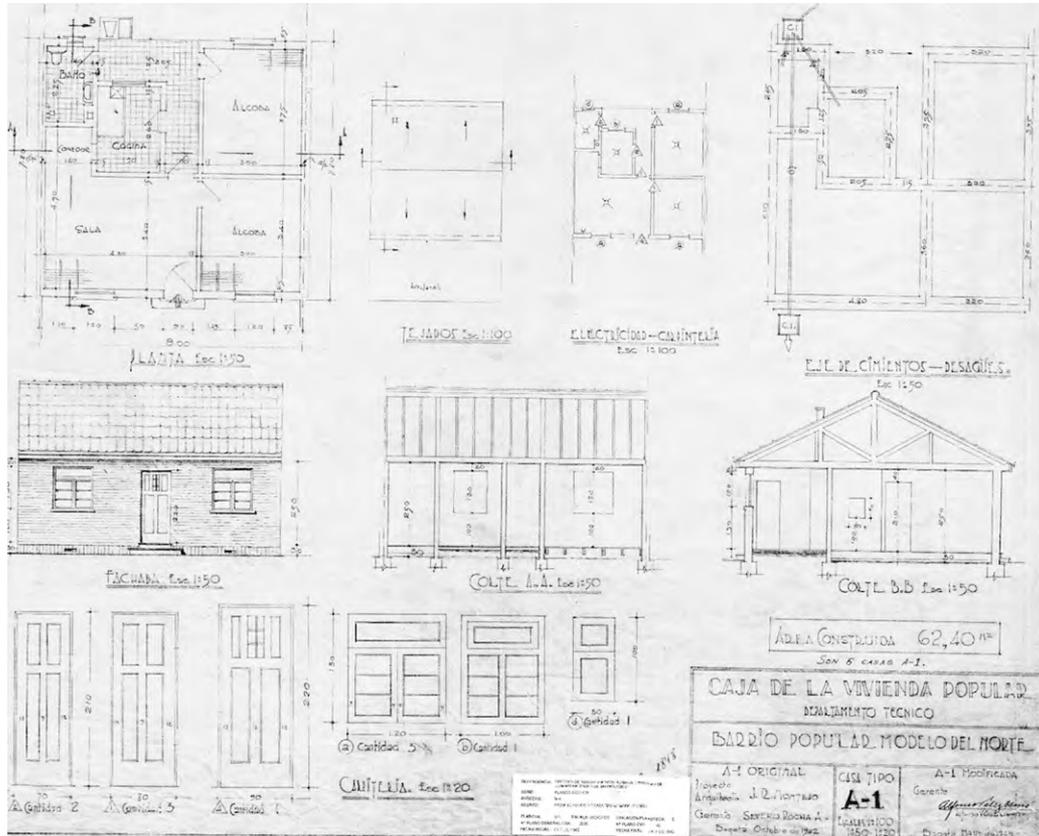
Planos casas tipo Popular Modelo Norte. Archivo Caja de Vivienda Popular
